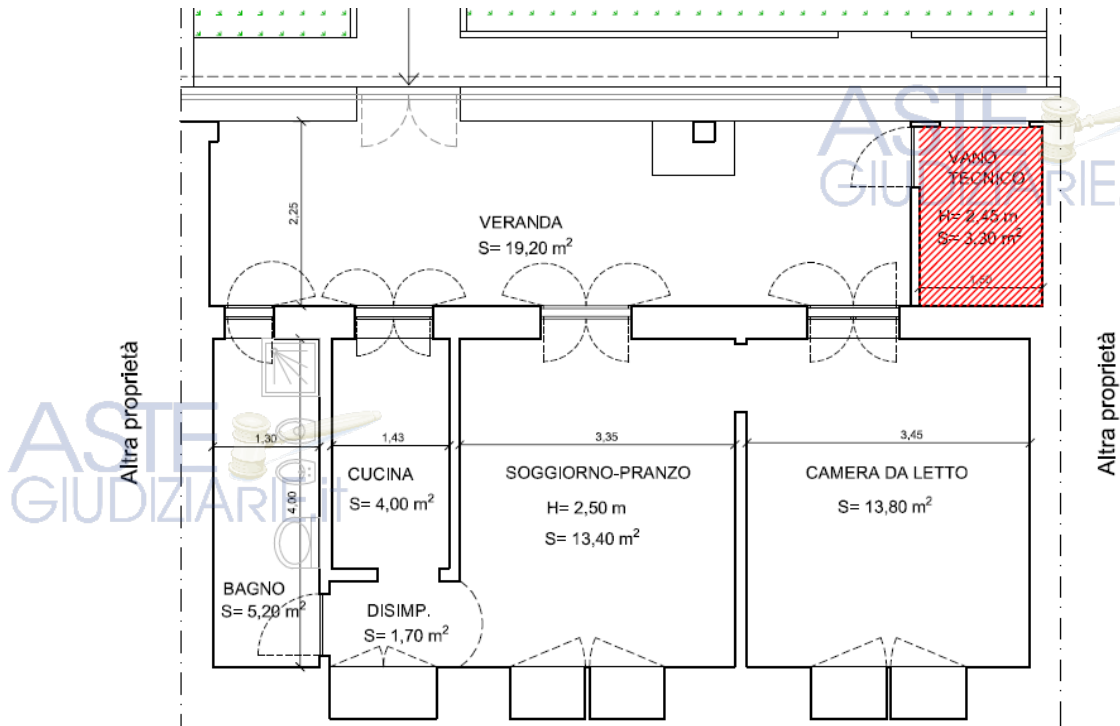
Vano tecnico (area in rosso) ricavato nello spazio veranda con tramezzi di tomponago e porta di ingresso.
